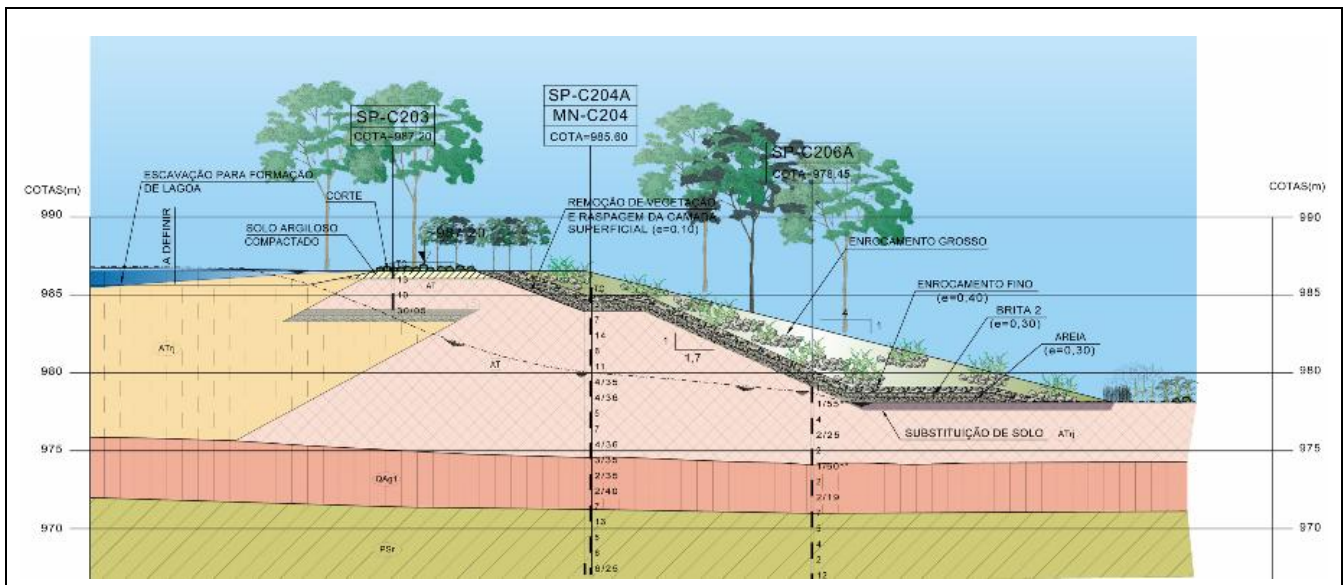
Execução das obras de descomissionamento da Barragem B1.
